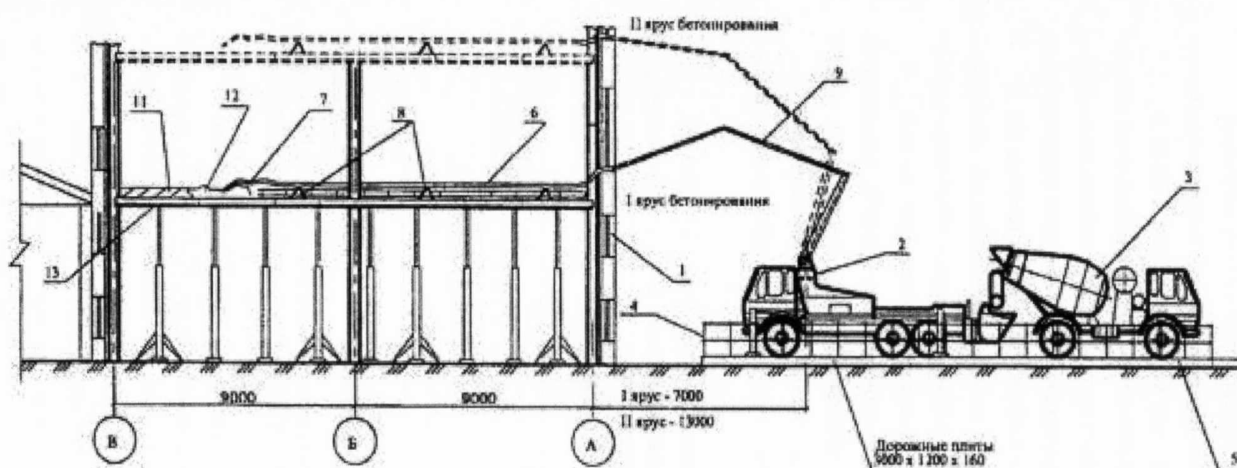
Схема организации рабочего места при выполнении работ по бетонированию перекрытия
